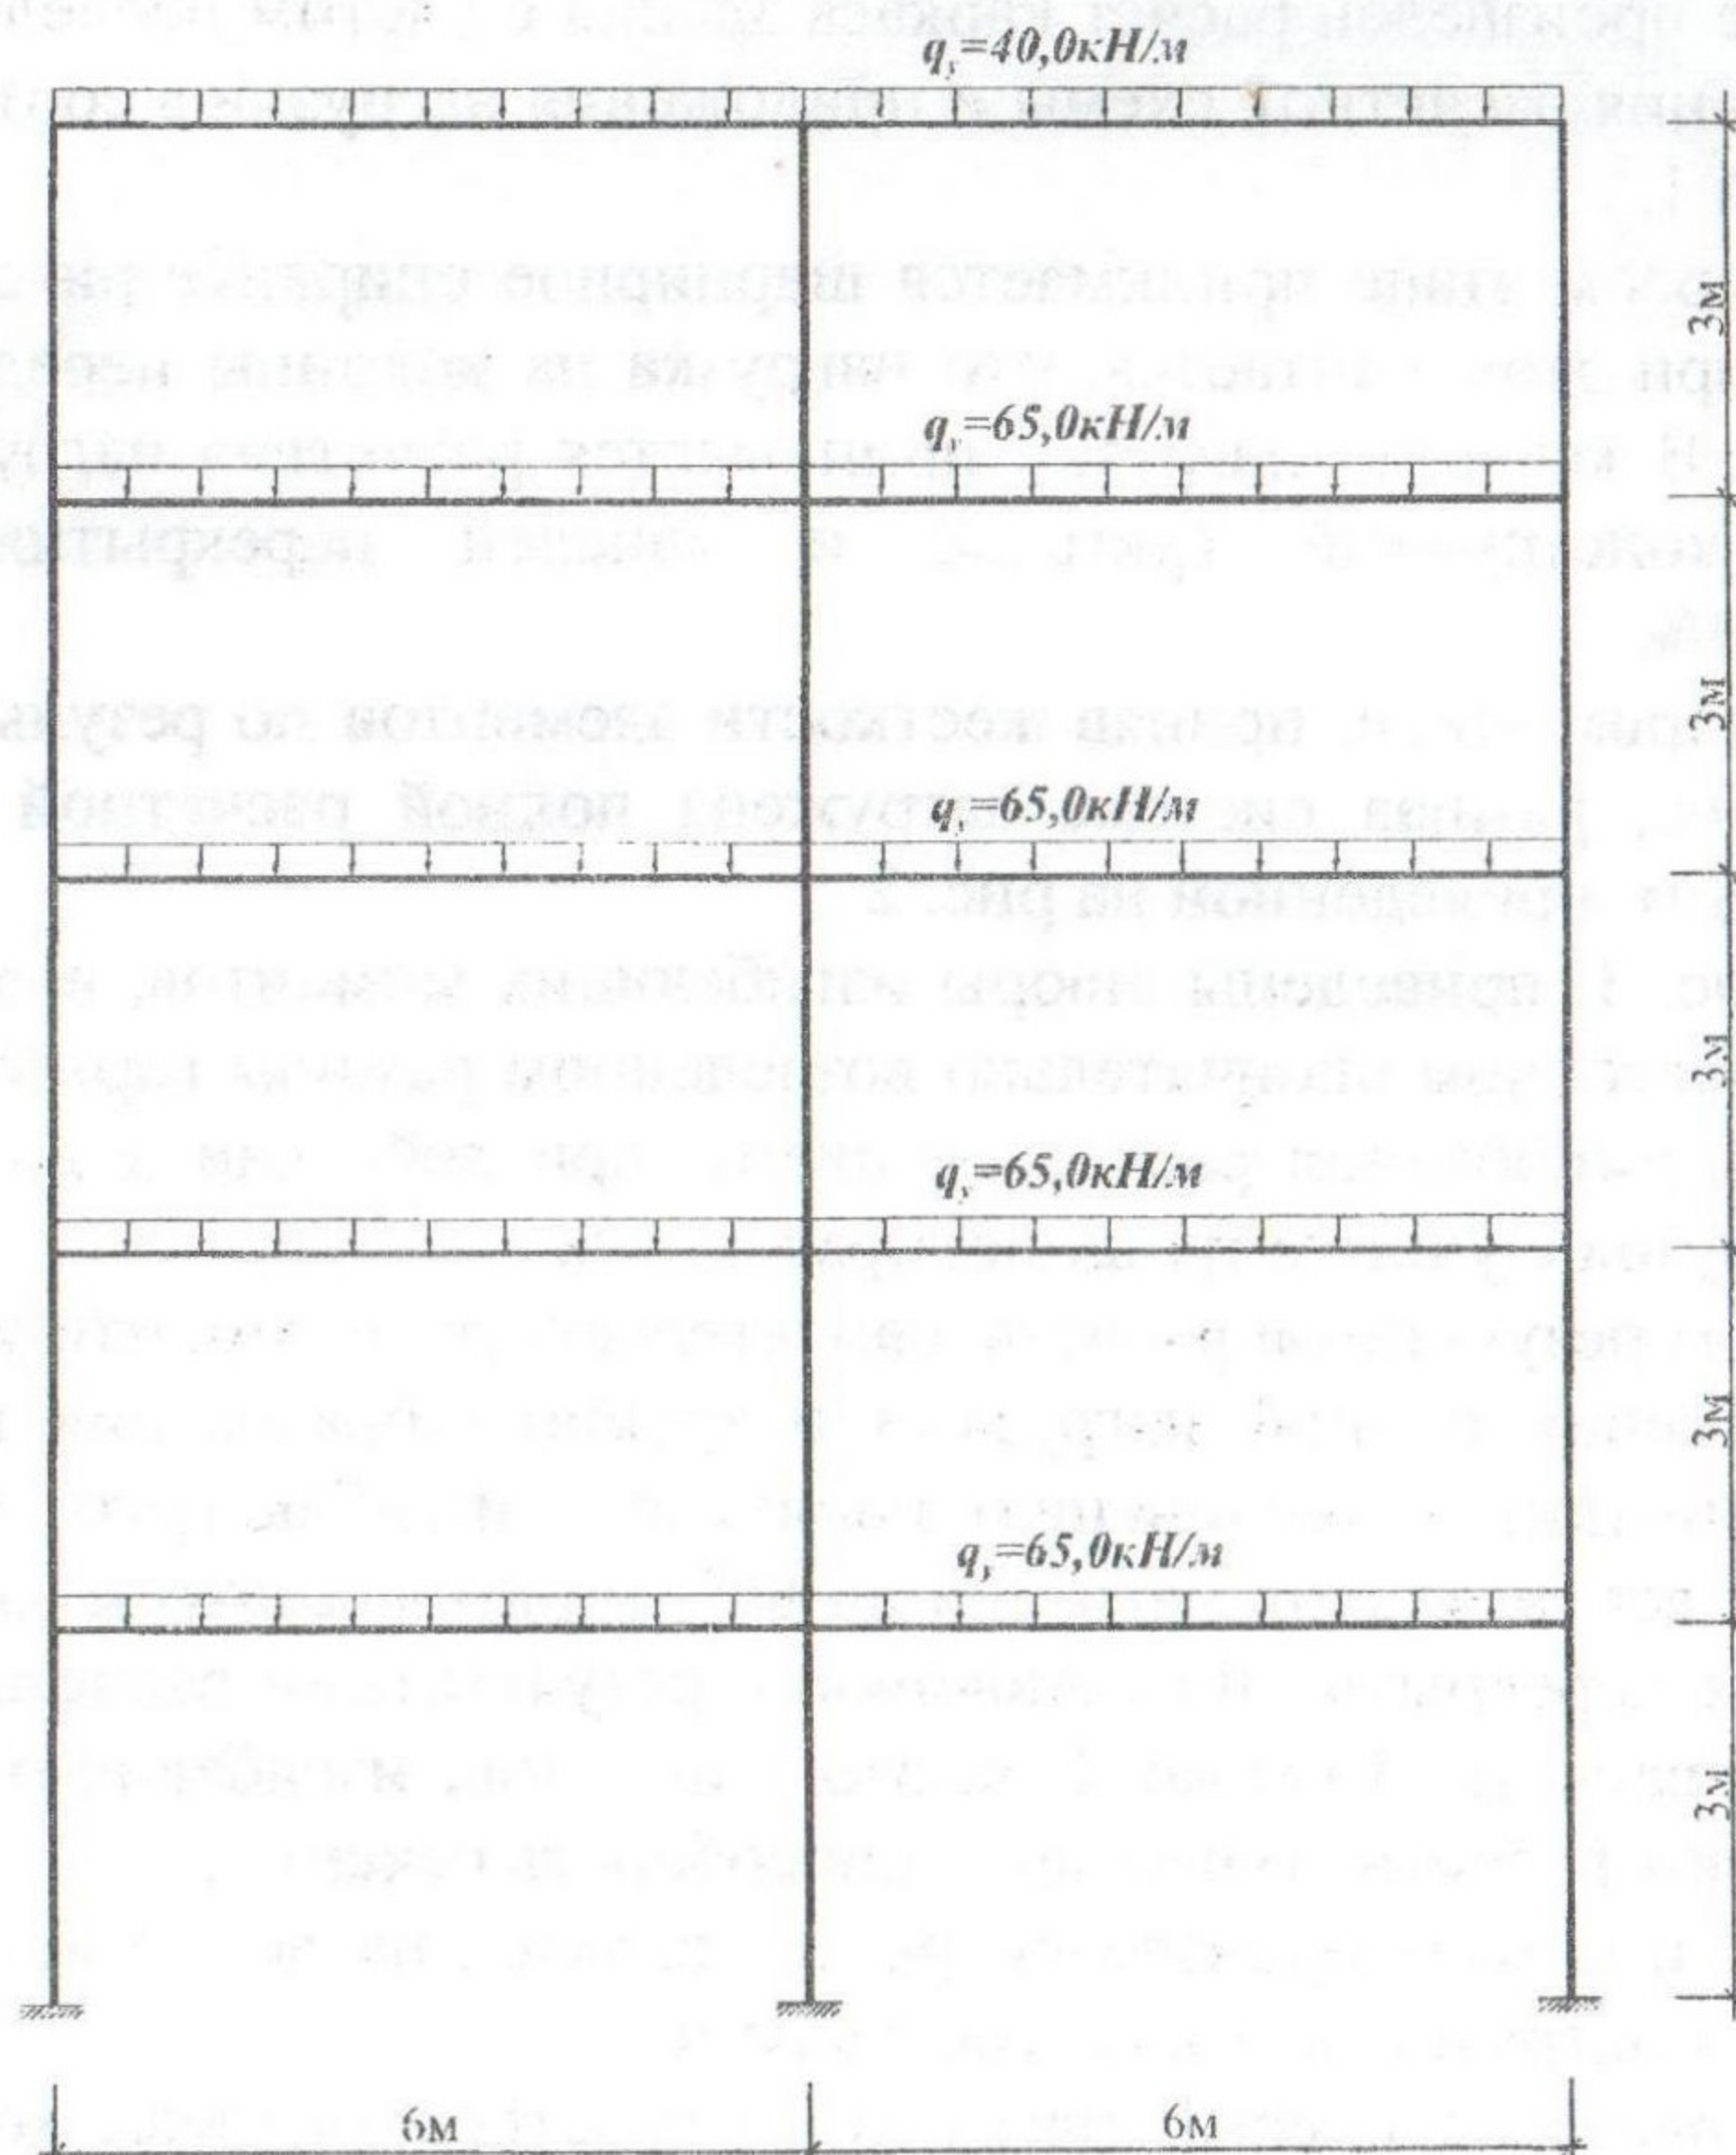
Расчетная схема пятиэтажного двухпролетного железобетонного рамно-связевого каркаса на действие полной расчетной нагрузки
